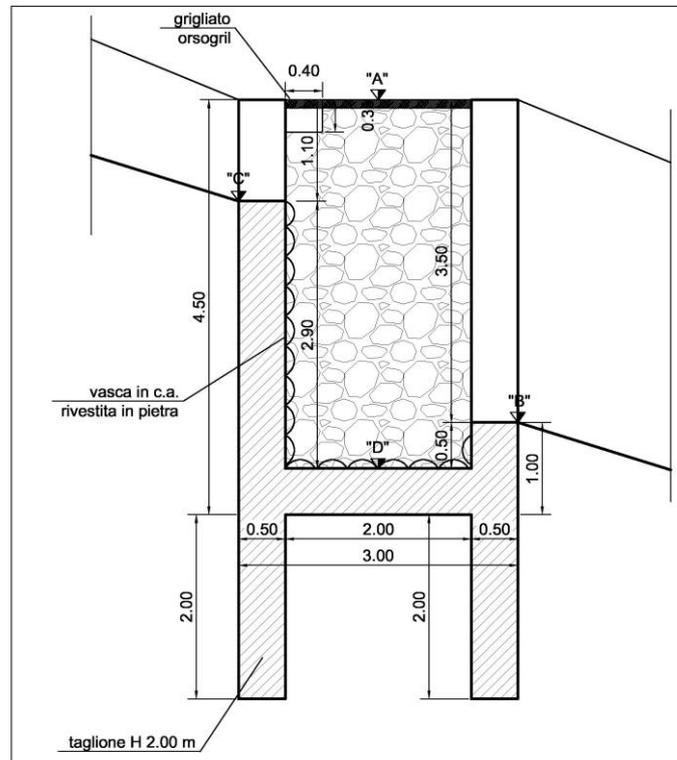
Compiuvio centrale – Vasca tipo Vi2-3-3 - sezione
